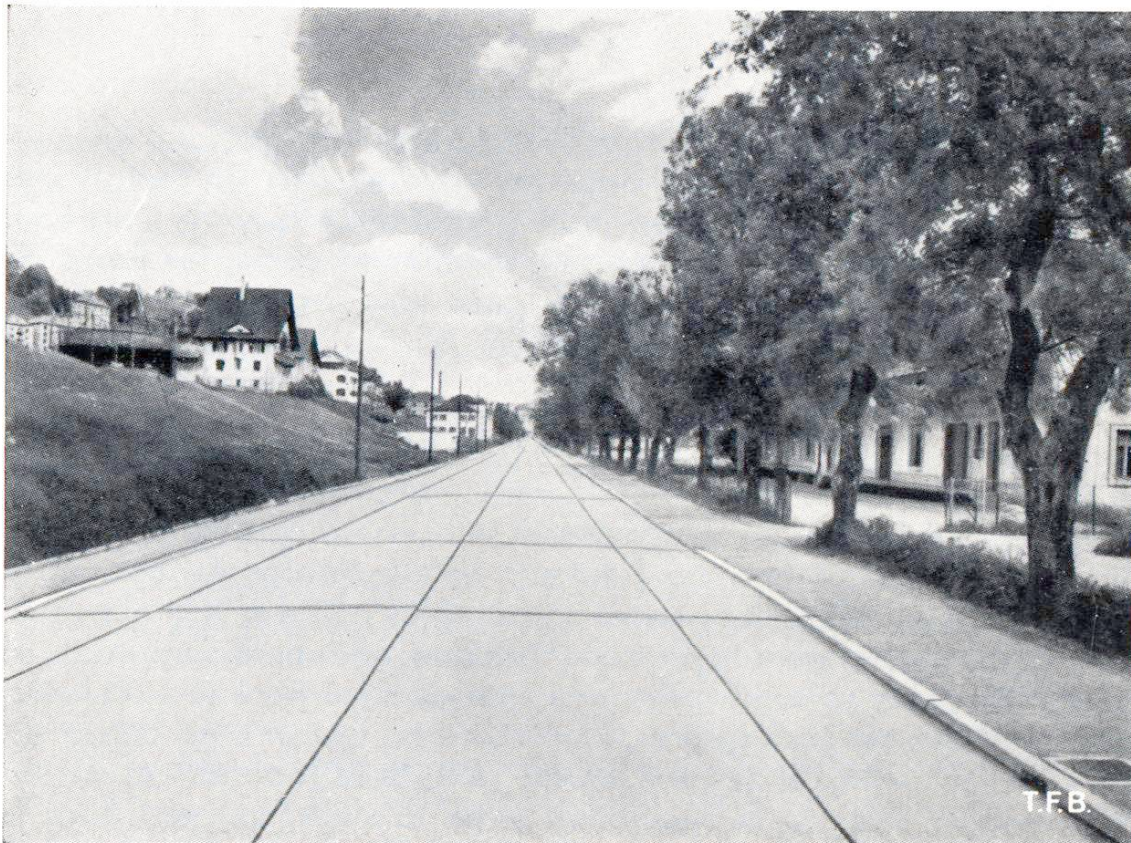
Col-des-Roches NE. Revêtement en béton construit en 1946 sur terrain tourbeux. Chaussée de 7,00 m, de chaque côté, une bande cyclable en béton rouge de 1,75 m avec bordures bétonnées sur place
